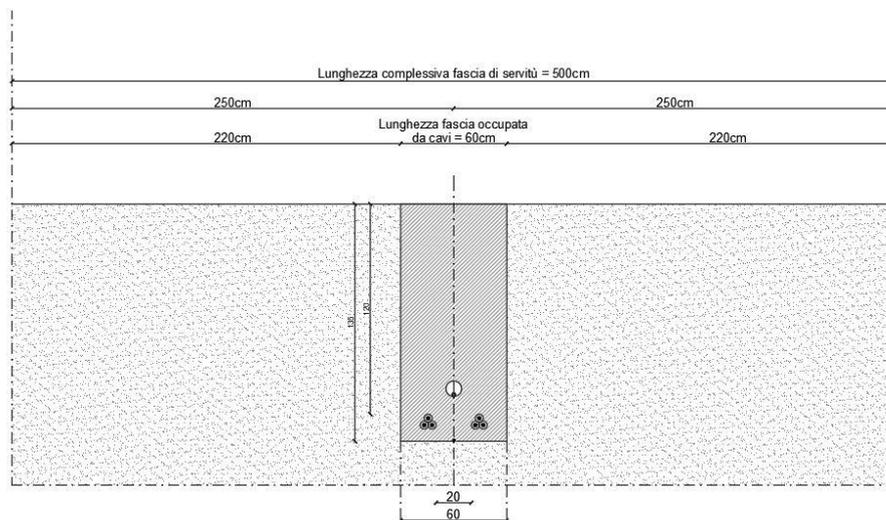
Sezione tipo scavo e fasce di rispetto per vincolo di servitù cavidotto esterno
